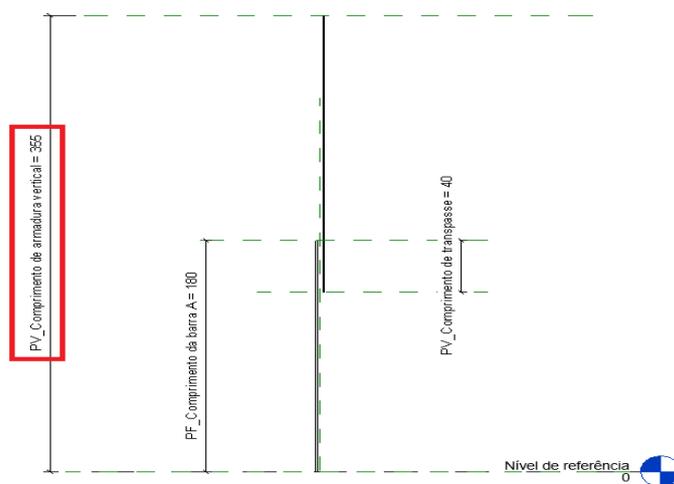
66 – Implementação do parâmetro de comprimento da armadura vertical.
